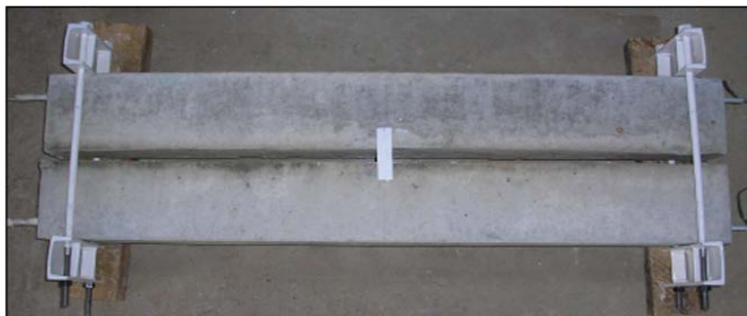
Sistema de pré-carga aplicado nas vigas de concreto
